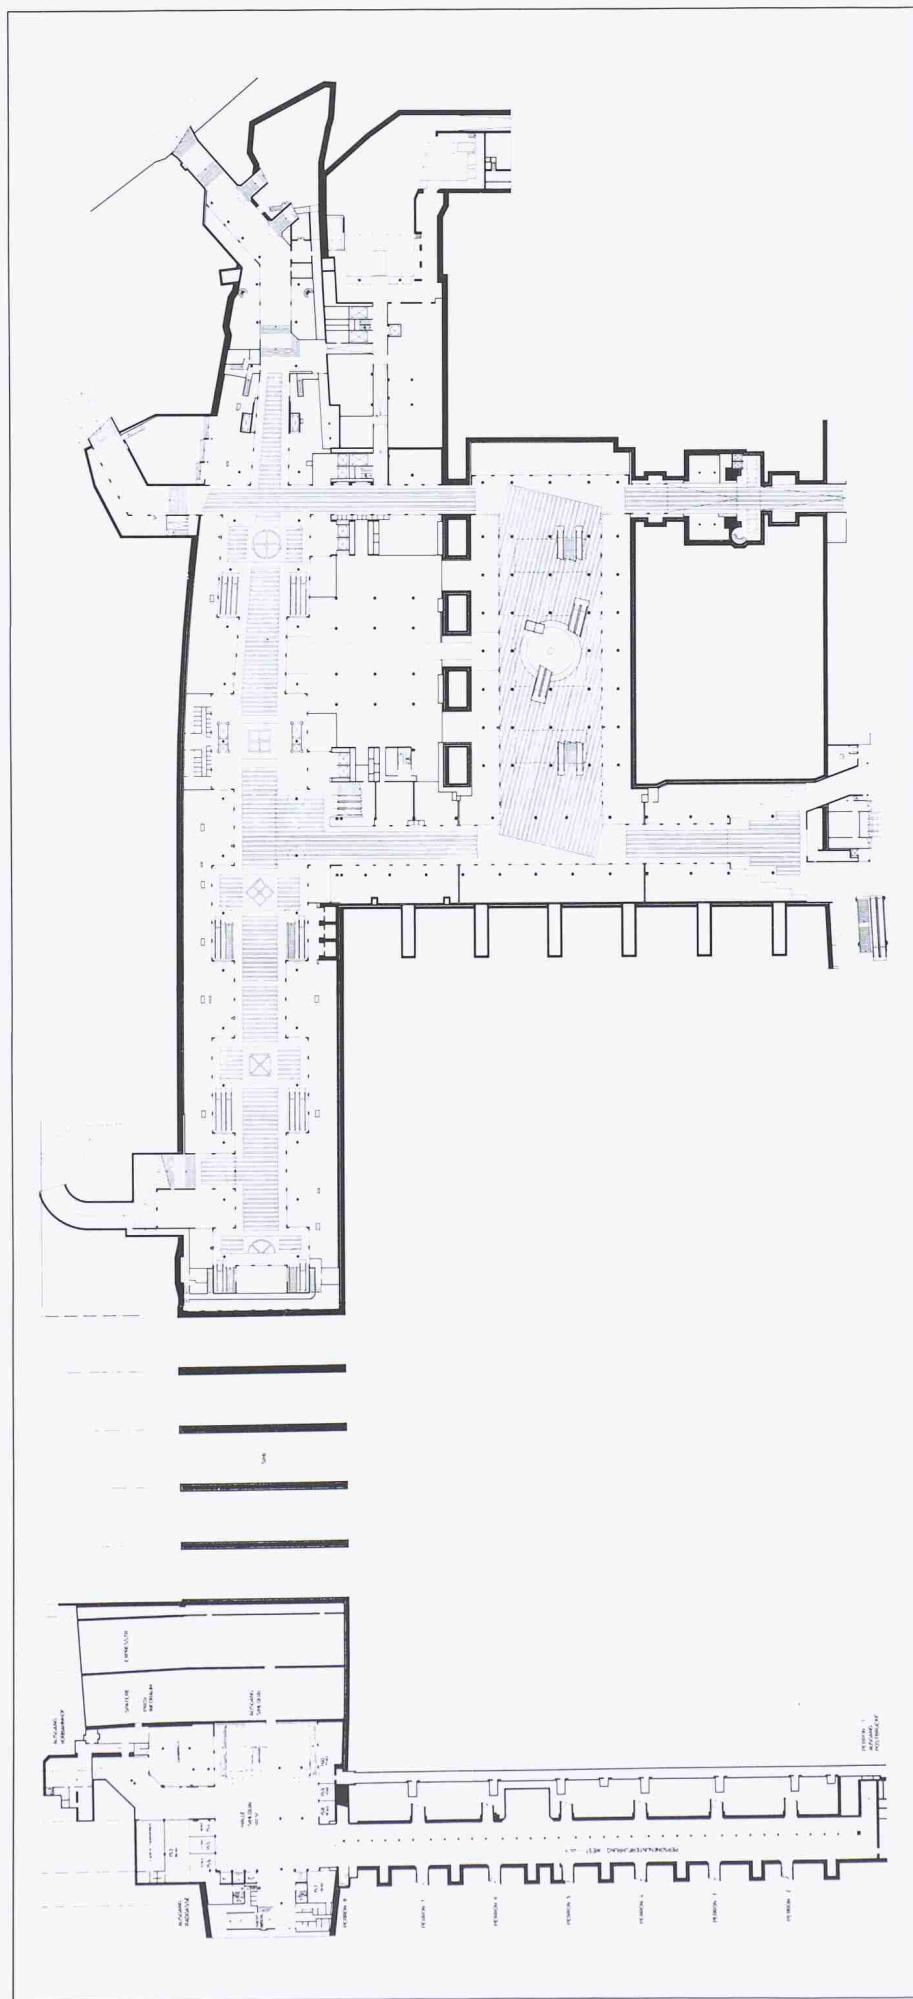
Grundriss Fußgängerebene (minus 2)
